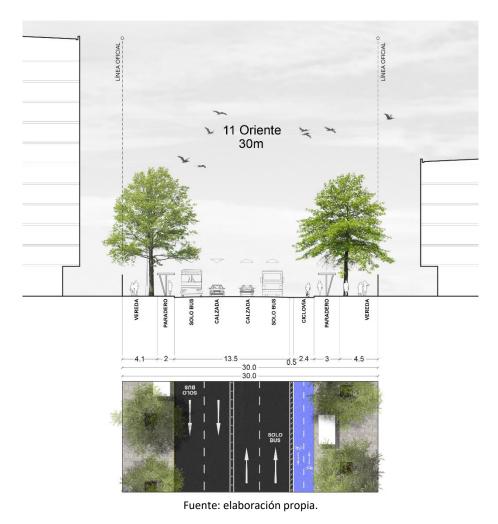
Perfil existente y propuesto Av. 11 Oriente (Entre 10 y 4 Norte)
